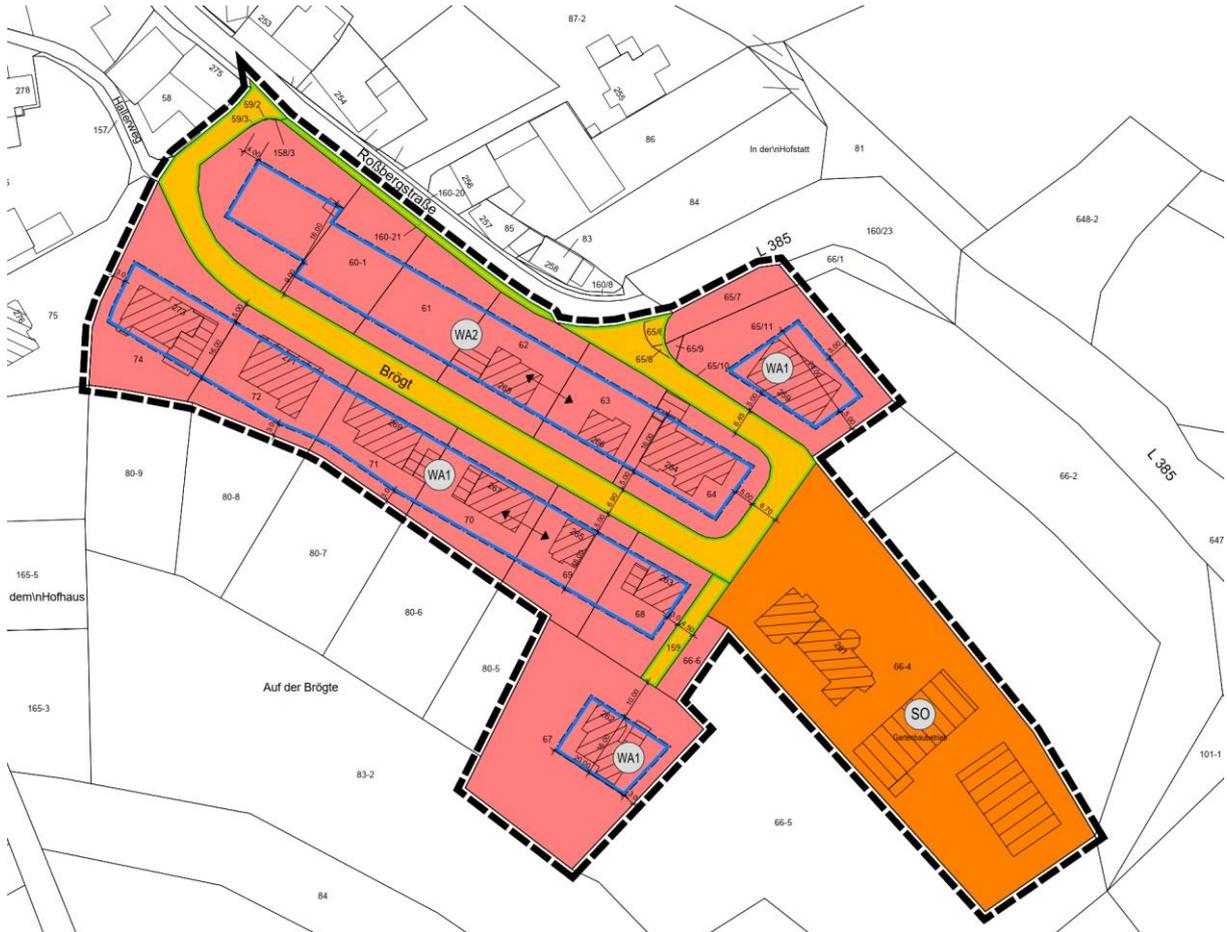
Angepasste Planzeichnung der 1. Änderung.
